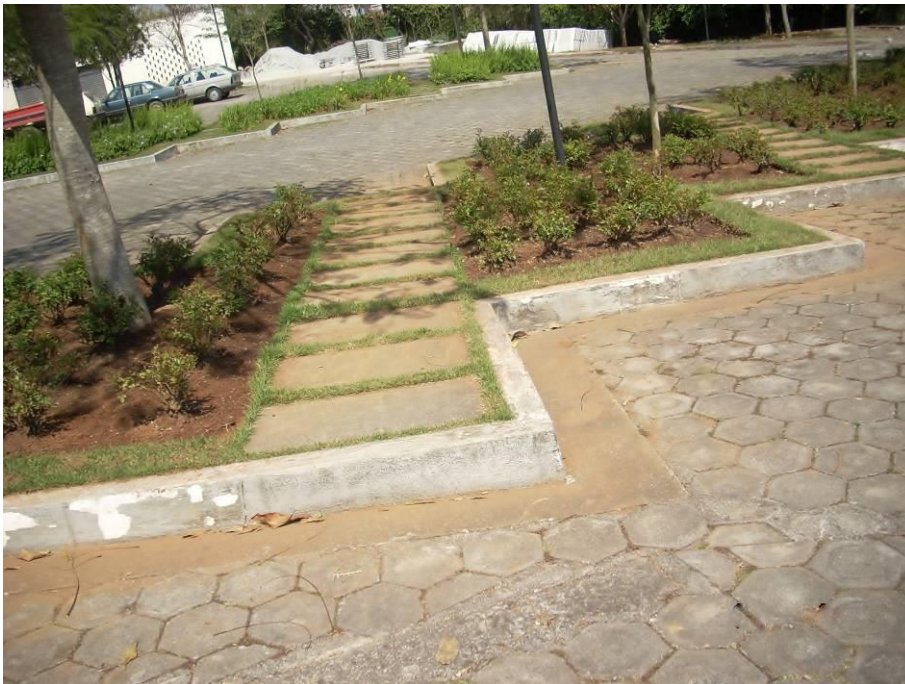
Detalhes da pavimentação, passagens de pedestres e canteiros. Ao fundo, à esquerda o Bloco de Serviços.
